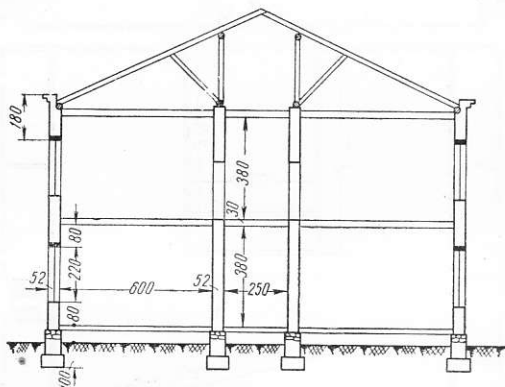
Поперечный разрез здания Туркменского филиала АН СССР
